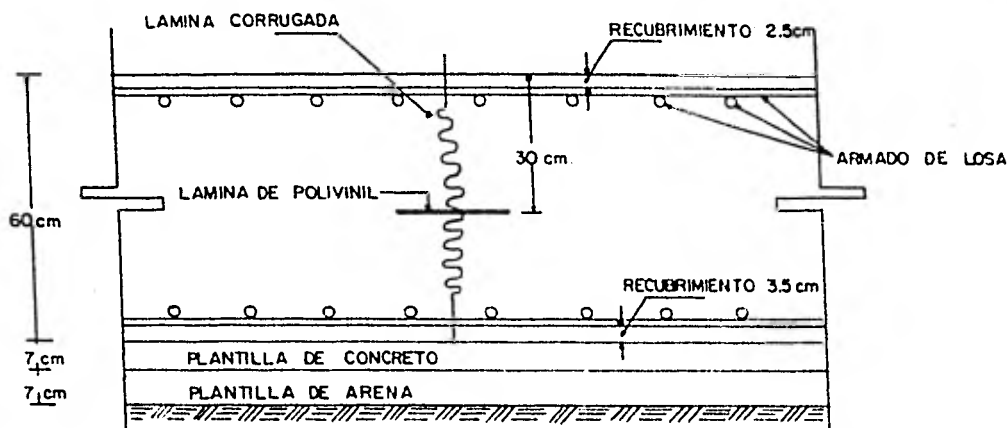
JUNTA DE COLADO EN LOSA DE CIMENTACION
